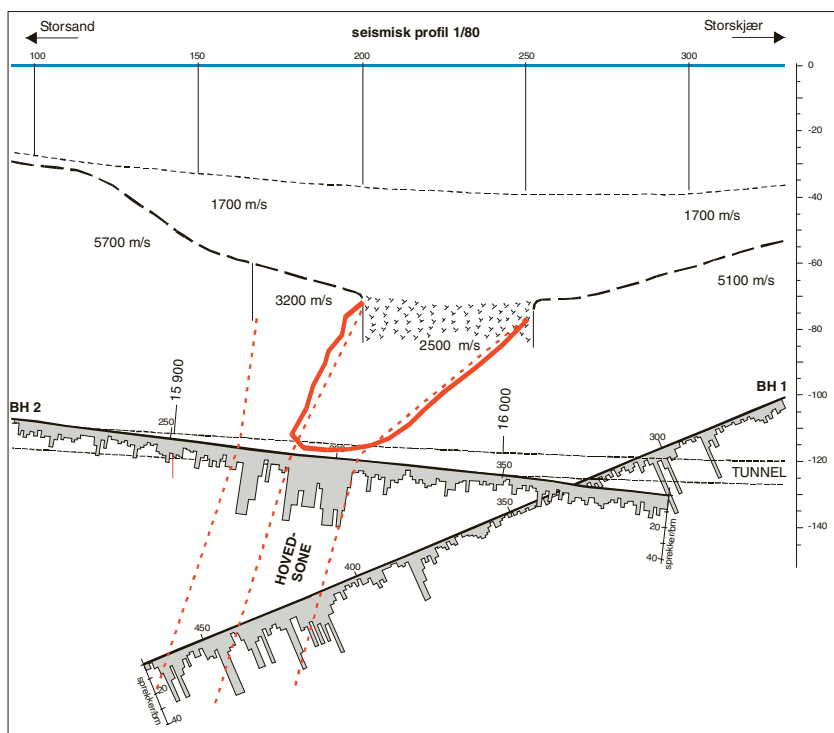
viser hvordan 'frysesonen' ble oppdaget under drivingen av tunnelen.
